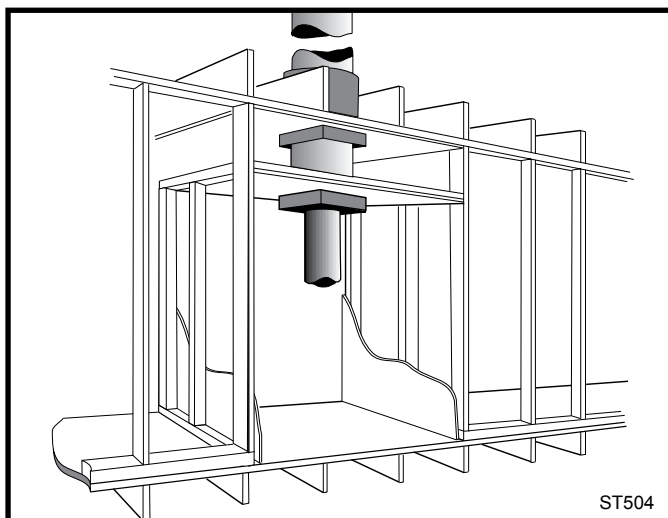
Vue en coupe de l'installation d'une alcôve.
